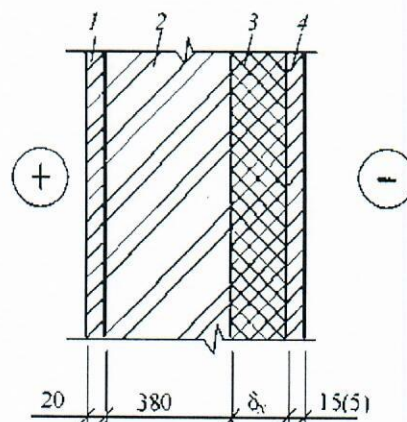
Вариант 3-й конструкции наружной стены:
